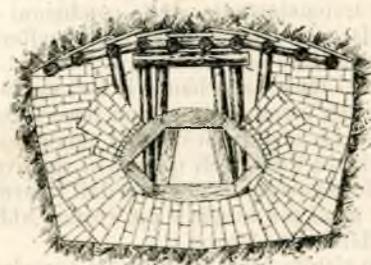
Sistema di costruzione precedente coll'aggiunta dell'arco provvisorio.
